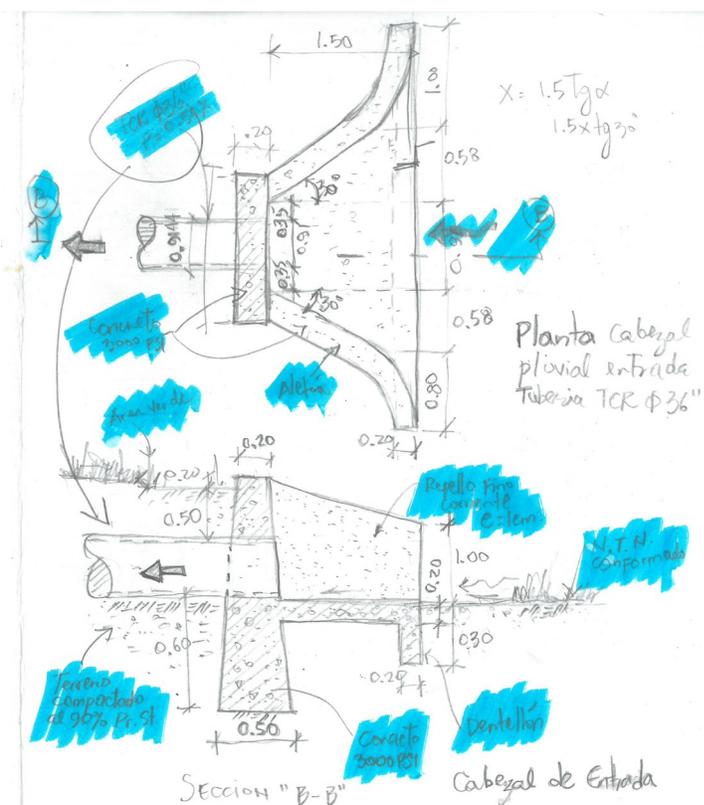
Boceto: Detalle de Cabezal Pluvial
